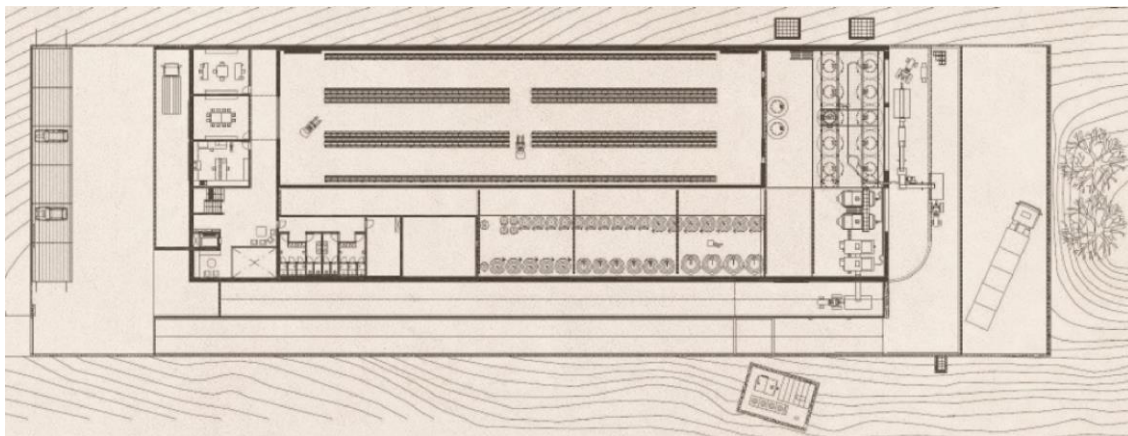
Planta do piso 1 da adega Mayor ²³⁹
